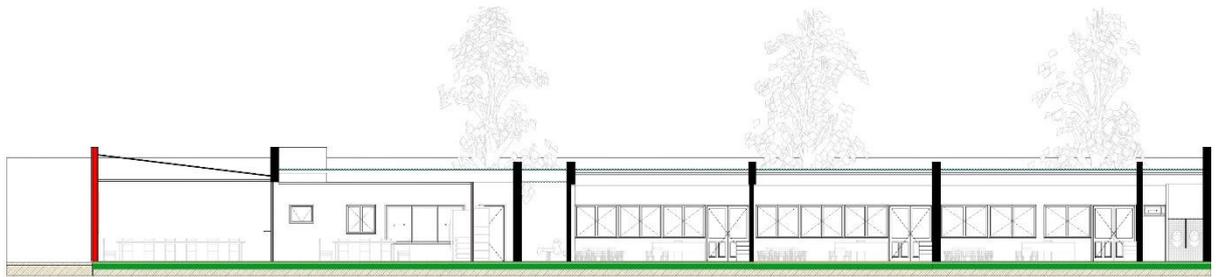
Anteproyecto arquitectónico: remodelación del edificio existente – Corte longitudinal.
